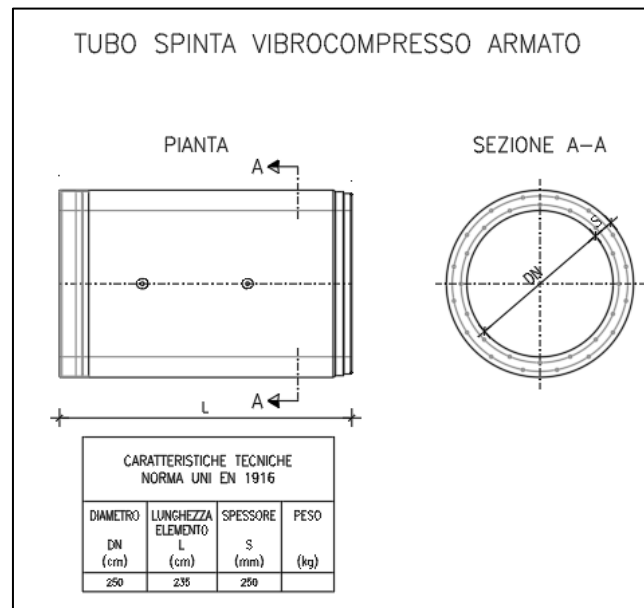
Tubazione di spinta in cls armato vibrocompresso.
